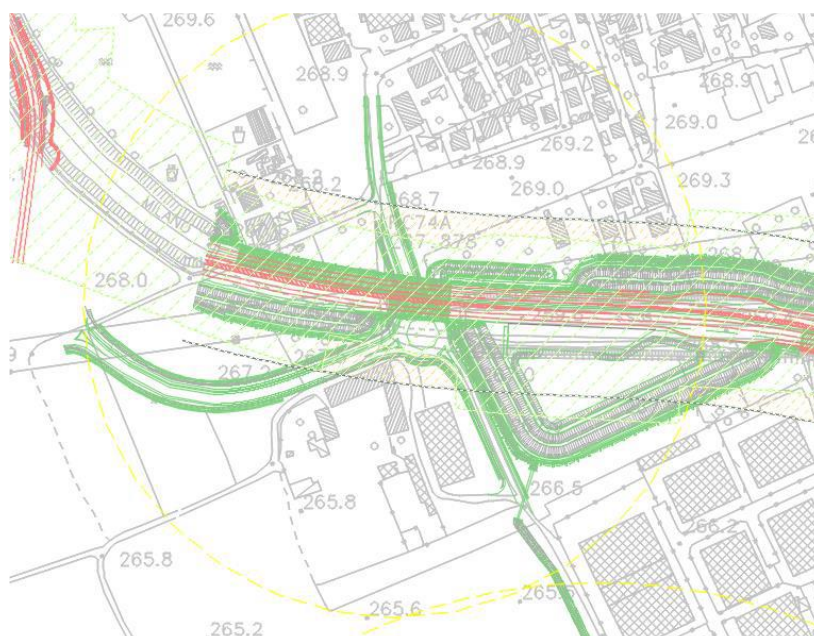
Modifica progettuale B2-11 (in verde PD – in rosso PE)
